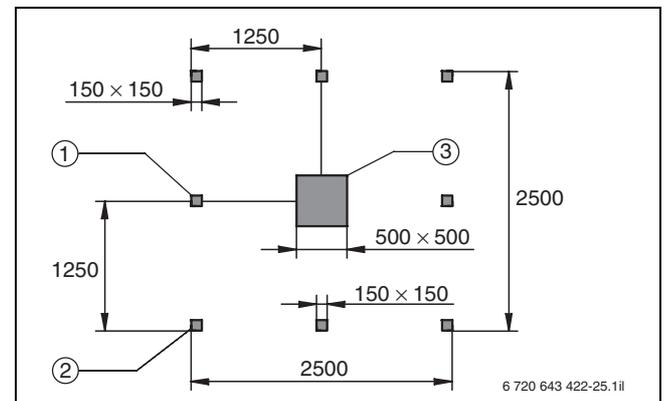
Belastungspunkte/Fundamentplan am Beispiel GS-25 (Maße in mm)
